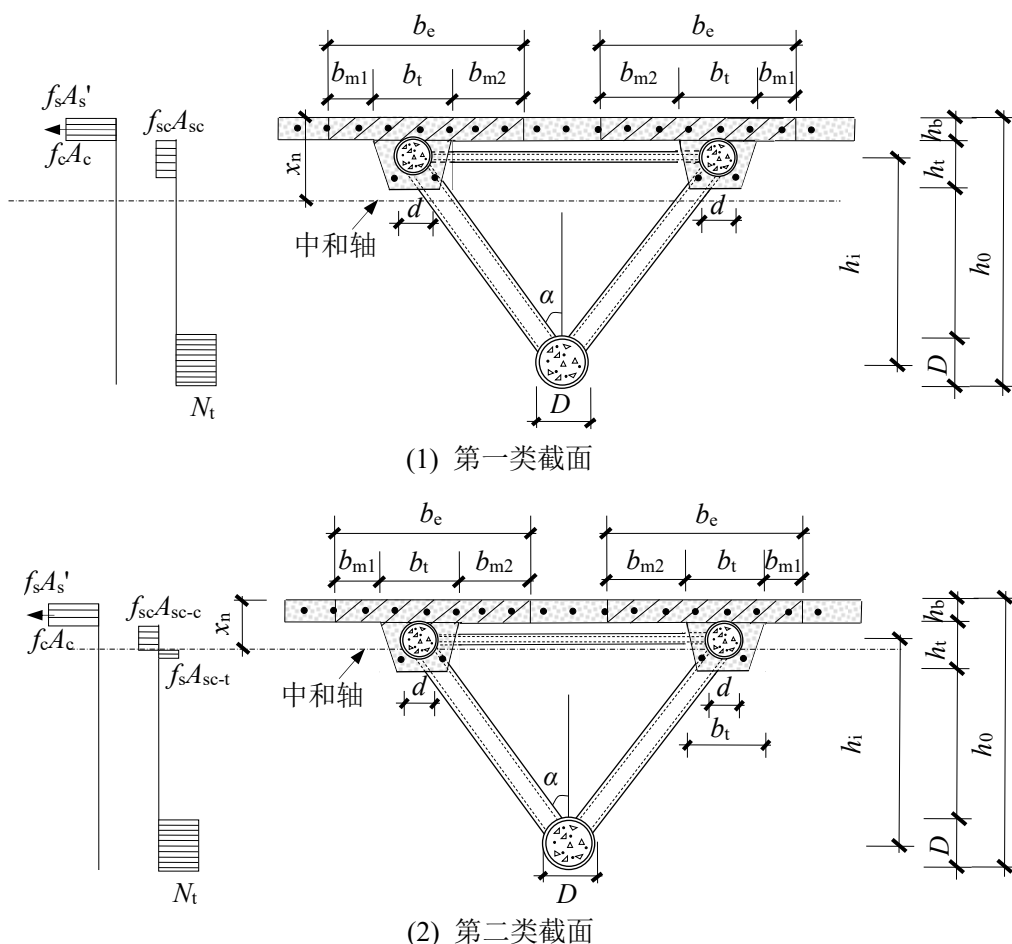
带钢筋混凝土板的桁式钢管混凝土构件截面示意图（三肢）
